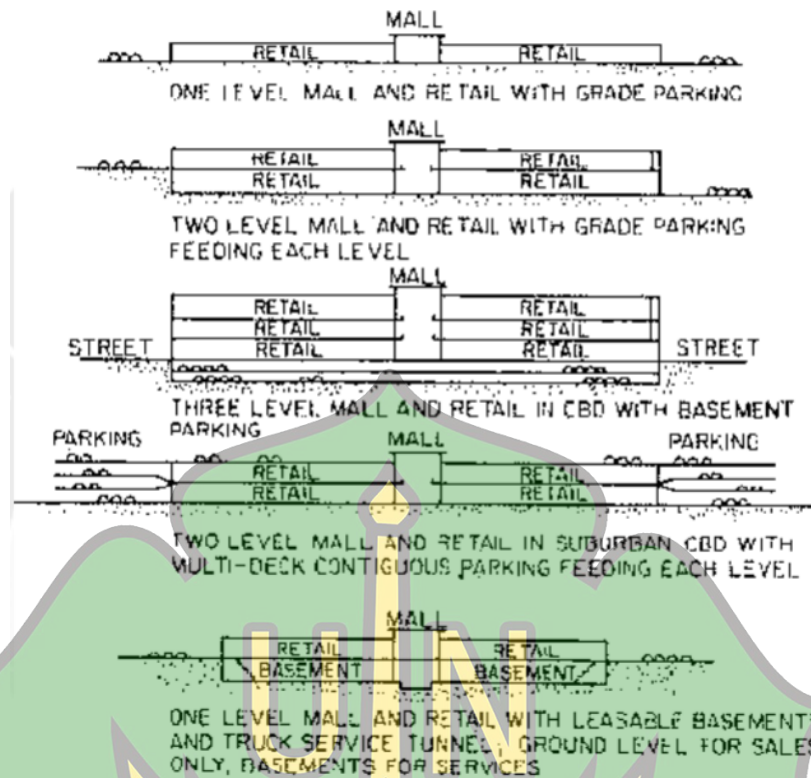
Susunan Layout Denah Pusat Perbelanjaan
